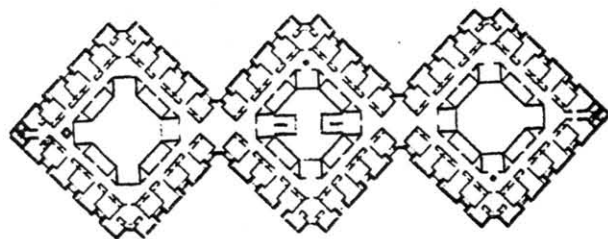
Eleanor Donnelley Erdman Hall, Bryn Mawr, Pennsylvania, 1960-65. Planta.
